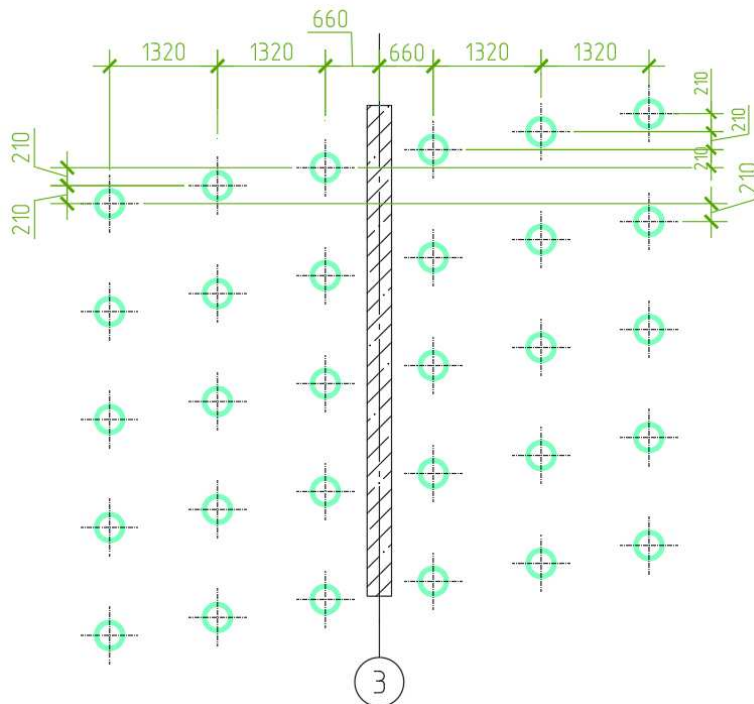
Схема к расчету плитного фундамента на продавливание
